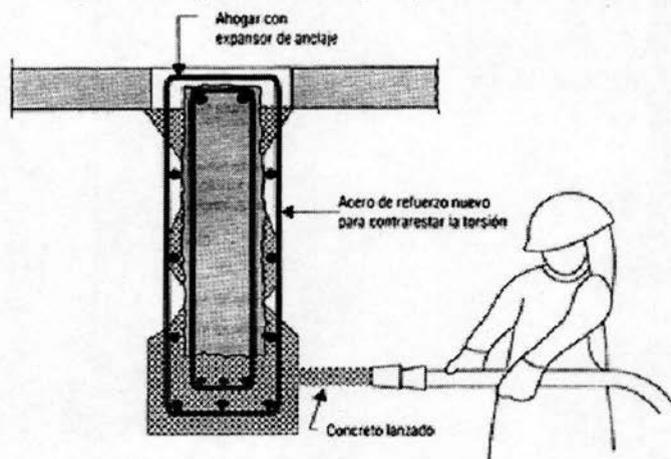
Reparación de vigas b) Refuerzo - Torsión
